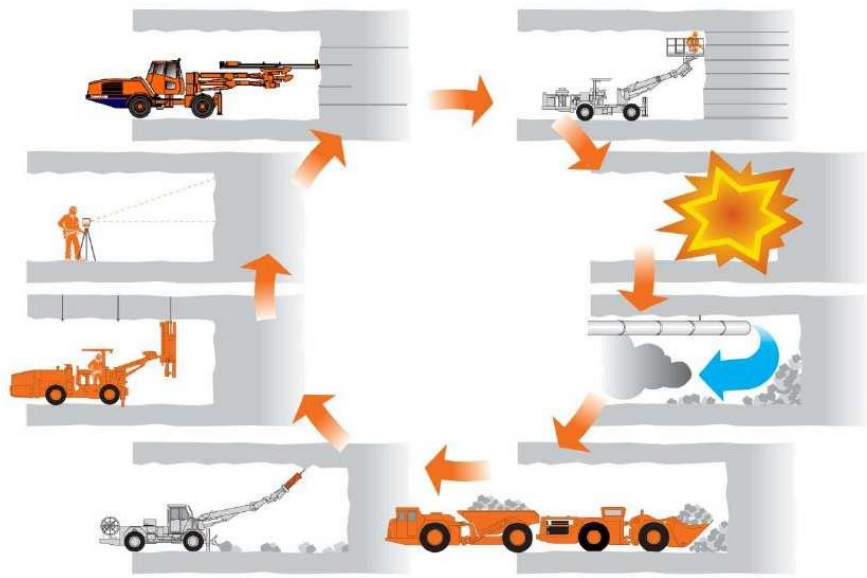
Esquema de fases de trabajo en la etapa de excavación y sostenimiento (N.A.T.M.).
